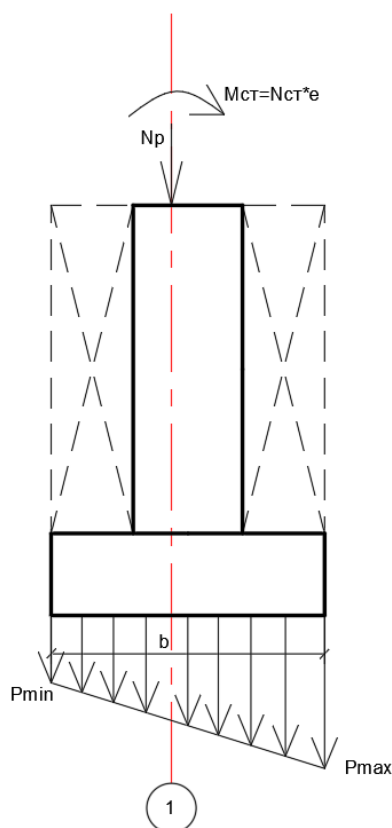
Фундамент и грунт на его обрезах, расположенный в осях 1/Б-В
